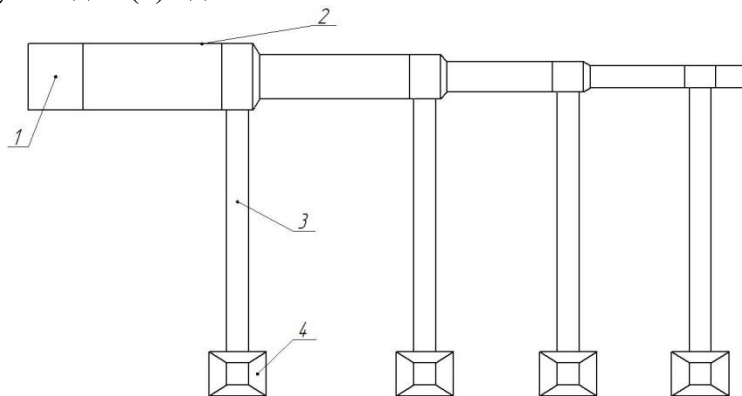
Схема установки оборудования для вентиляции в нижней части помещения:
